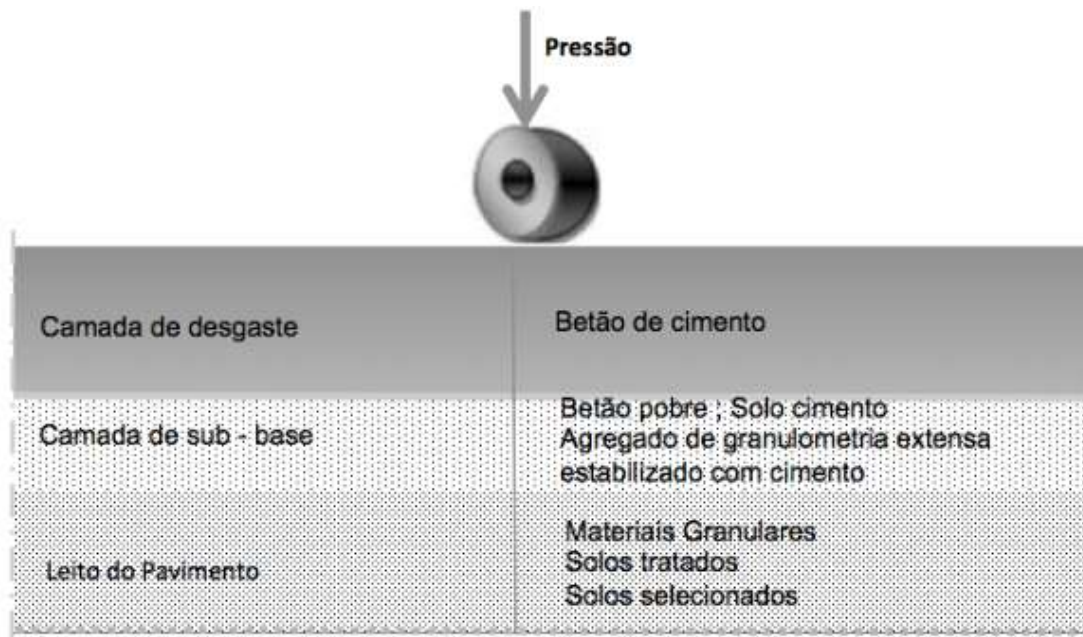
Pavimento Rígido (elaboração própria – adaptado de Picado Santos et al, 2011)
